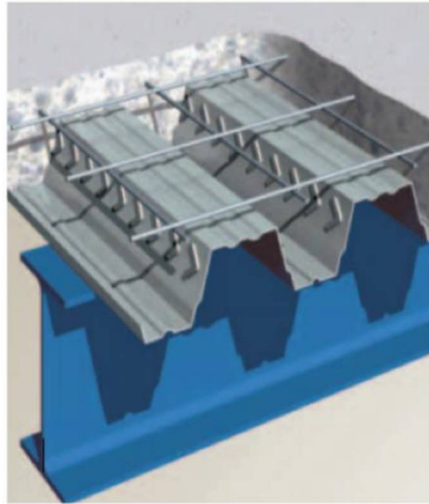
Варіанти сталобетонних перекриттів, розроблених за кордоном
